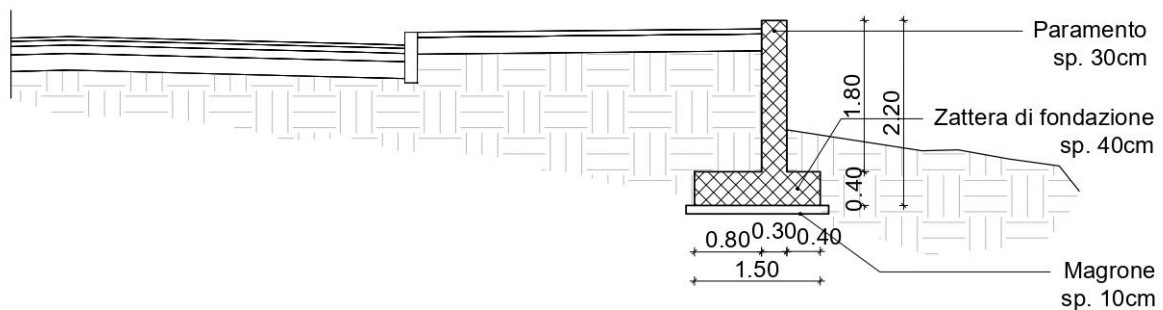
Sezione del nuovo muro di contenimento. Stralcio tratto dall'elaborato: ST-326222S01PF00STCA00001A
